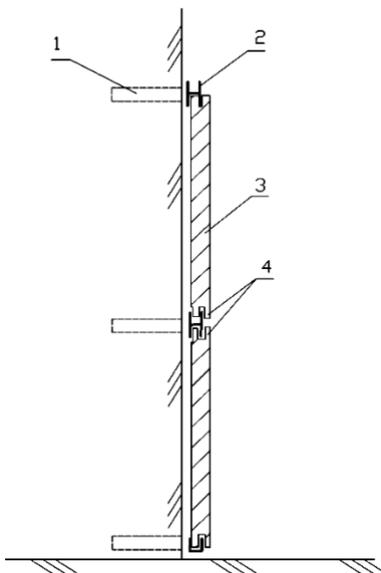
Безрастворный способ облицовки стен с боковой задвижкой плит:
